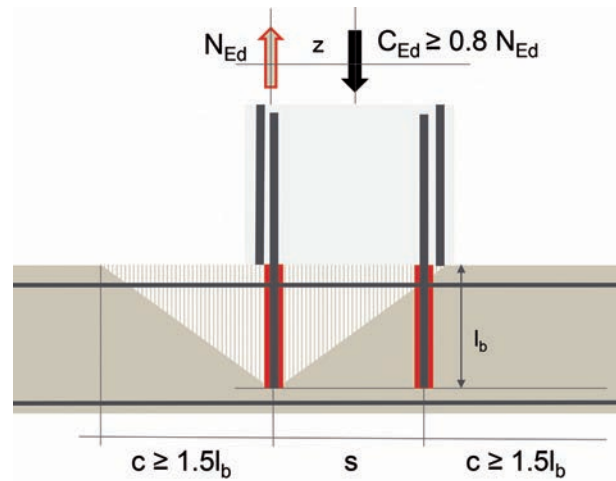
Einfluss eines an der Verbindung angreifenden Biegemoments auf die Betonausbruchlast der zugbeanspruchten Bewehrungsstäbe
